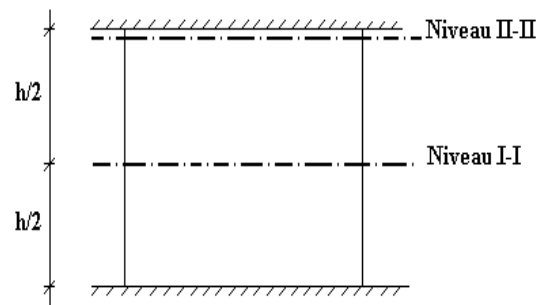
Schéma d'un voile plein et disposition du ferrailage
